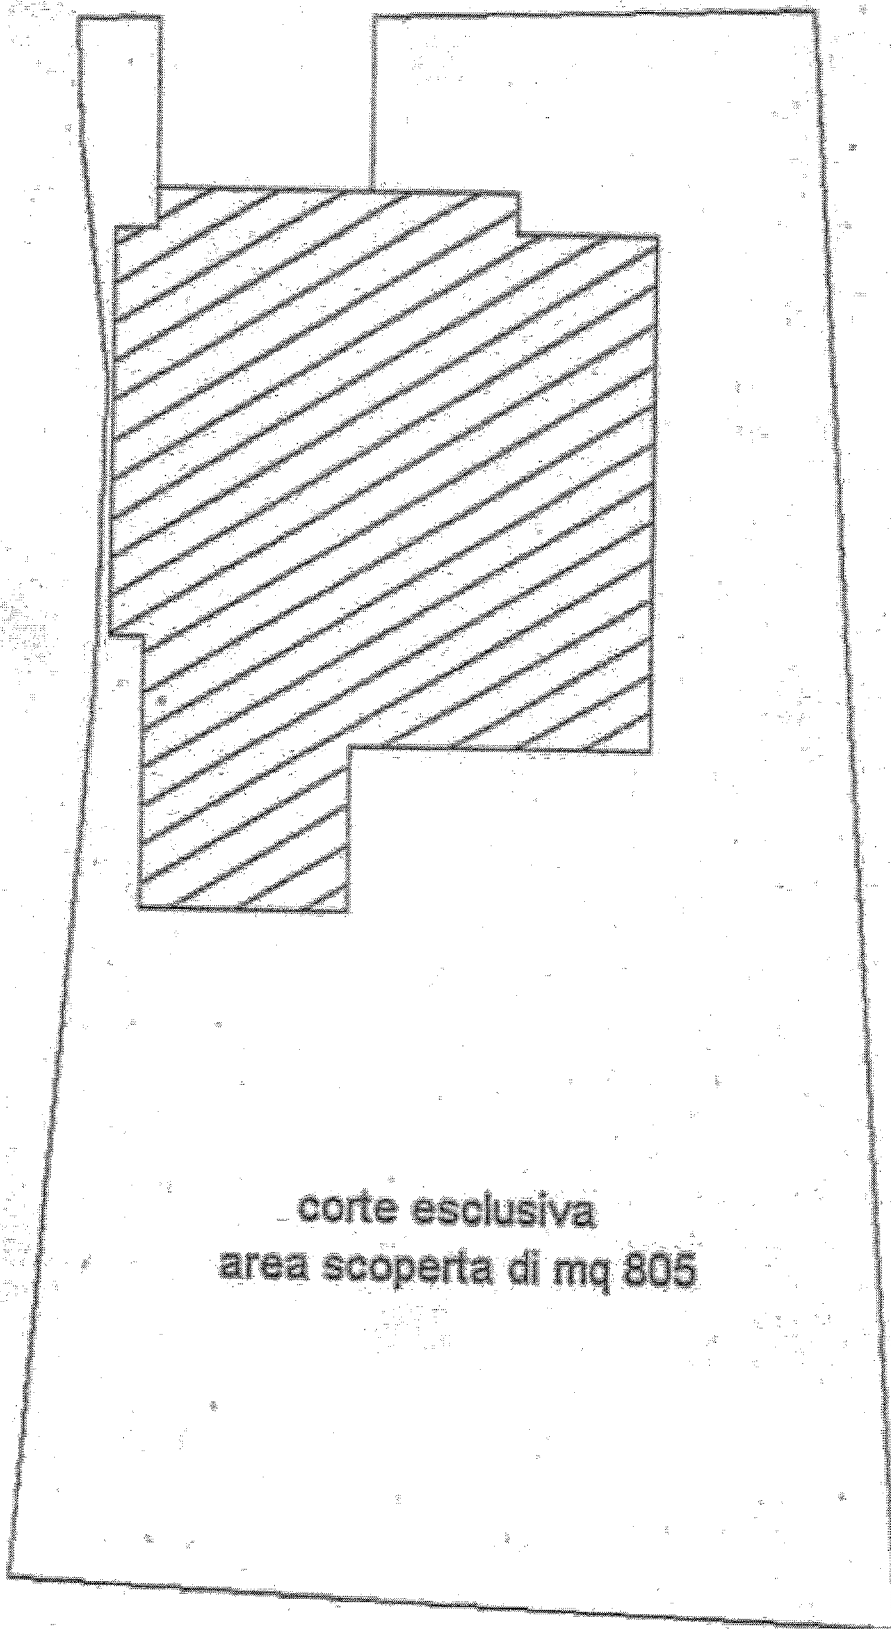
planimetria catastale, sez. B foglio 3, mappale 39 sub 6 (fuori scala)
